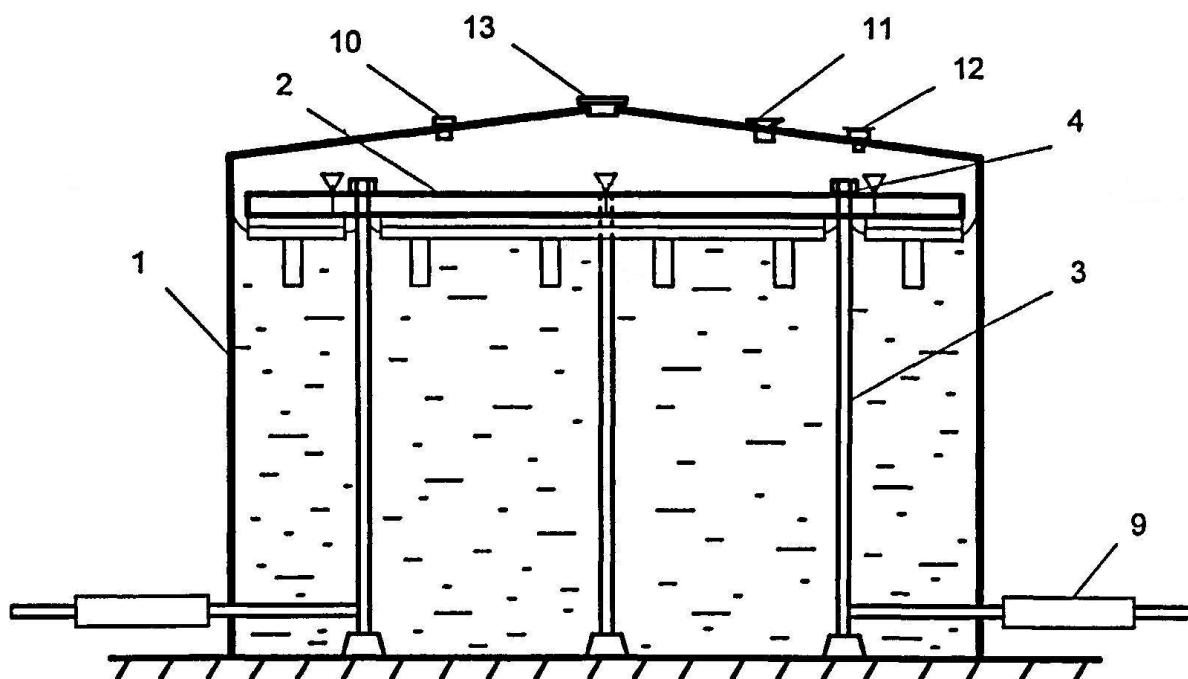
Вертикальный резервуар с плавающей крышкой или понтоном: 1 – резервуар; 2 – плавающая крышка или понтон; 3 – направляющая стойка; 4 – заглушка; 9 – пускозапорное устройство; 10 – дыхательный клапан; 11 – световой люк; 12 – замерной люк; 13 – вентиляционный патрубок
